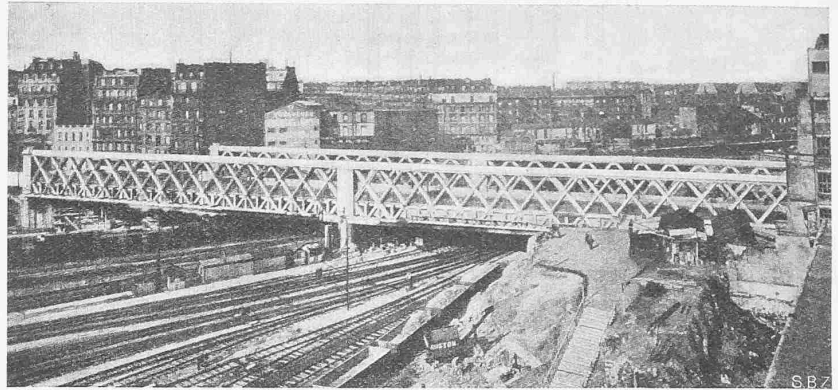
Ueberführung der Rue Lafayette: Eisenbeton-Fachwerk, Trägerhöhe 10,40 m.
